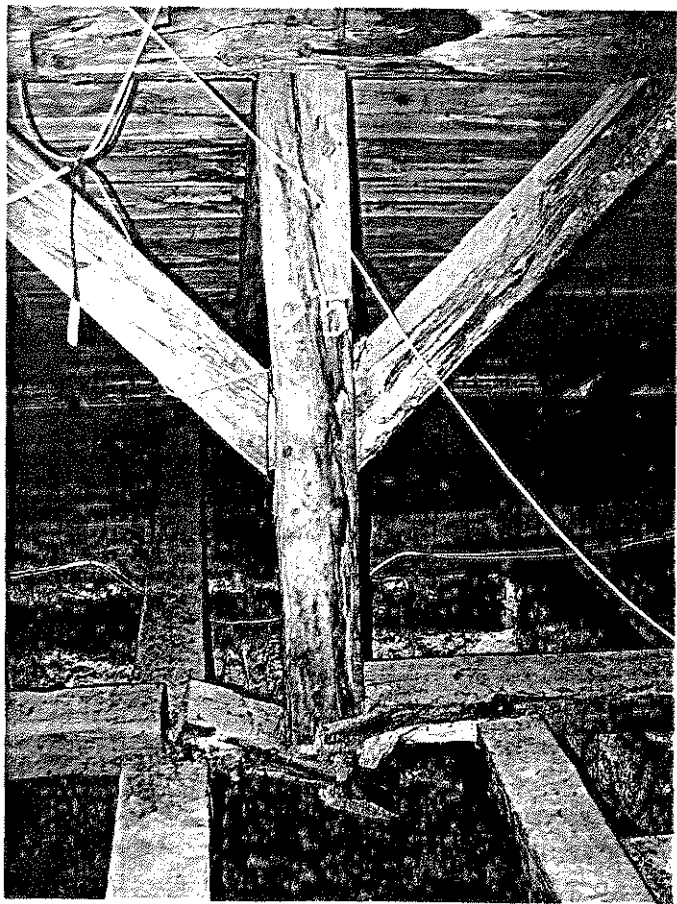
Więźba dachowa – widok belek podwlinowych.
